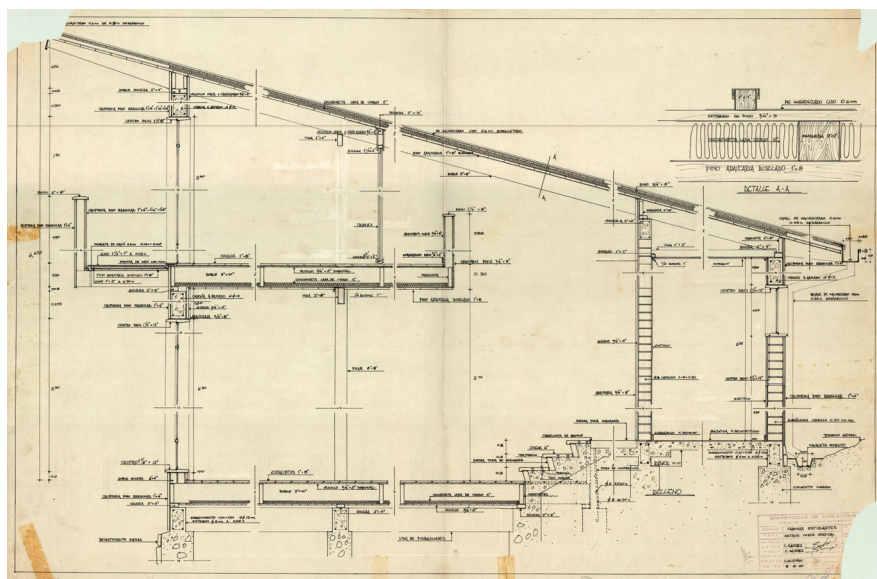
Corte constructivo anteproyecto, con entresijos de madera en ambos niveles (fuente: Archivo DIRSER, 1960).
